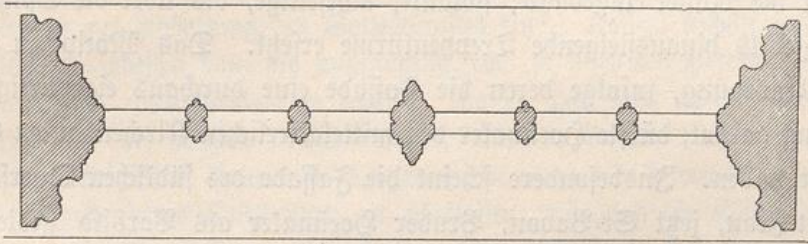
Gent. Jesuitenkirche. Profil des Mittelfensters der Fassade.
